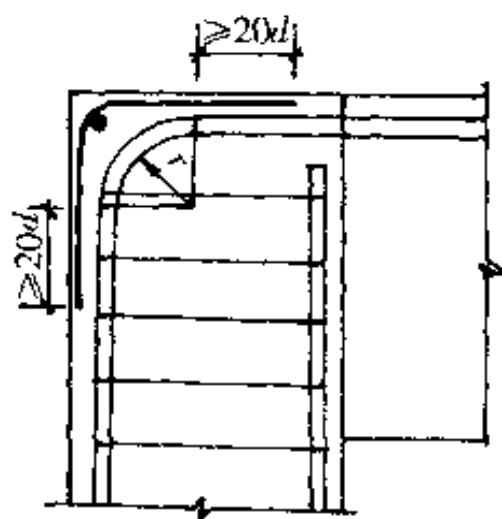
顶层端节点钢筋弯弧外的附加钢筋
